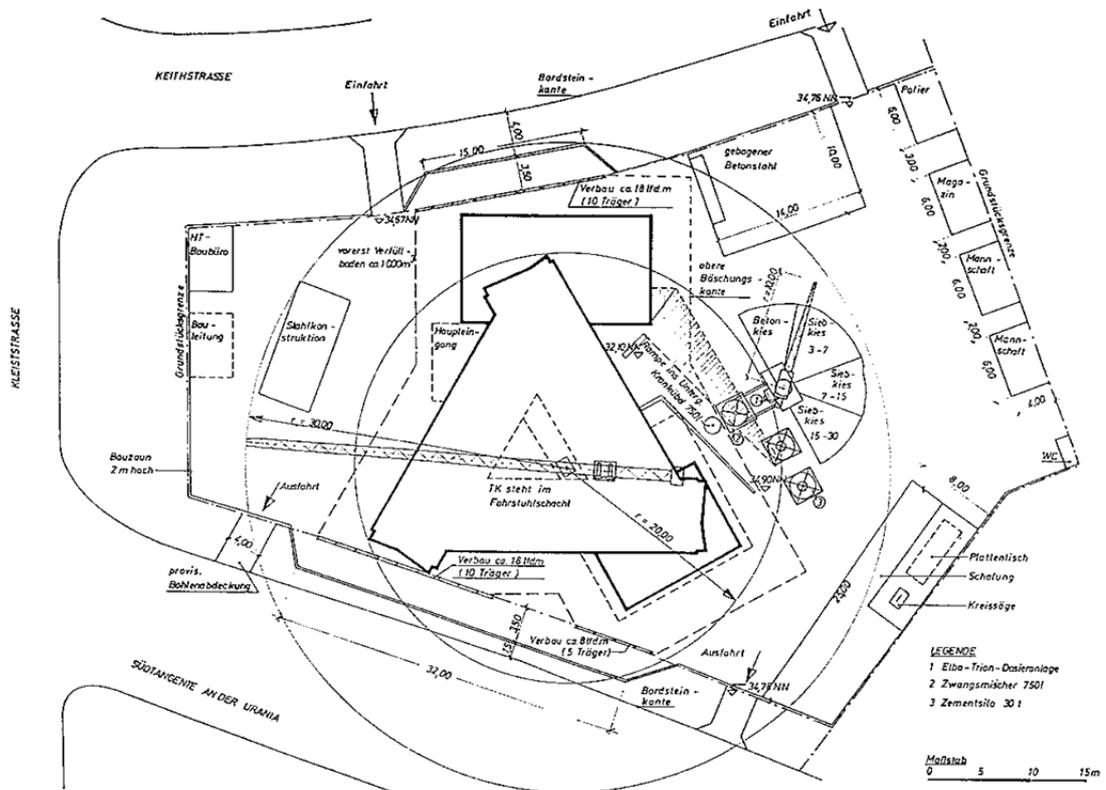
Baustelleneinrichtung- Haus der Werbung, Berlin [1]
